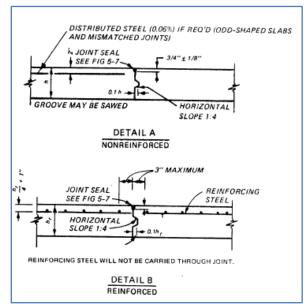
Juntas de Construcción para losas apoyadas sobre el piso
